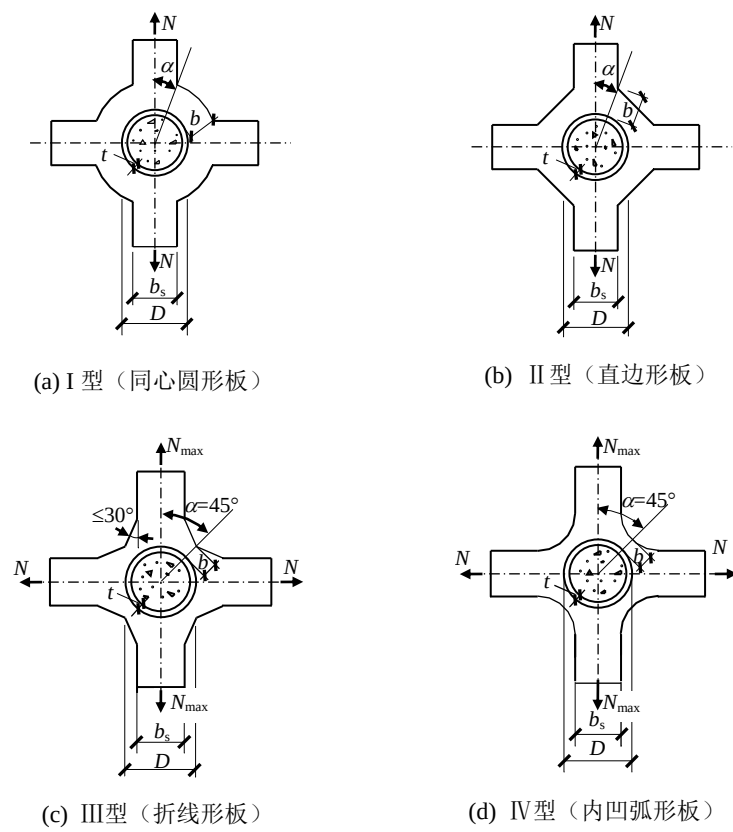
圆形钢管再生混凝土加强环板类型示意图
